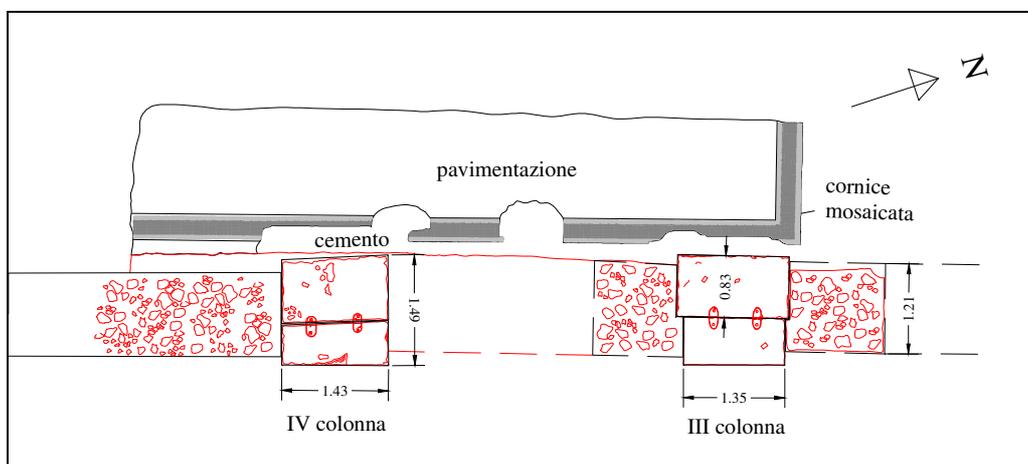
angolo nord/est pavimentazione in cementizio con cornice mosaicata, pianta di Alessandra Iodice.
